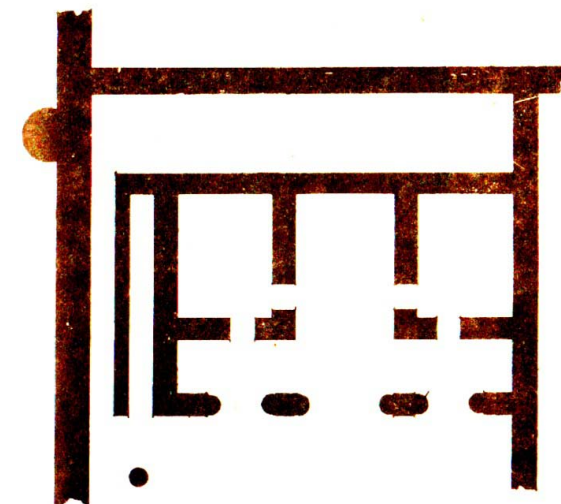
قصر الأخضر مخطط الطابق الأول (مس بل)
